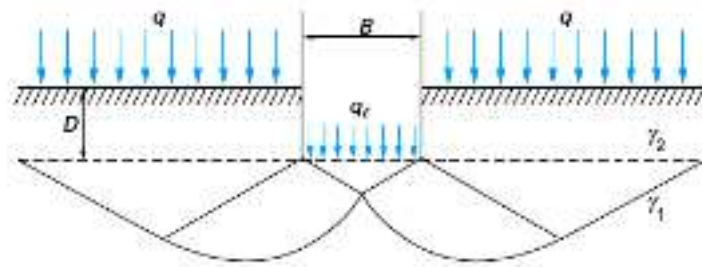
(a) Schéma de rupture d'une fondation superficielle.
